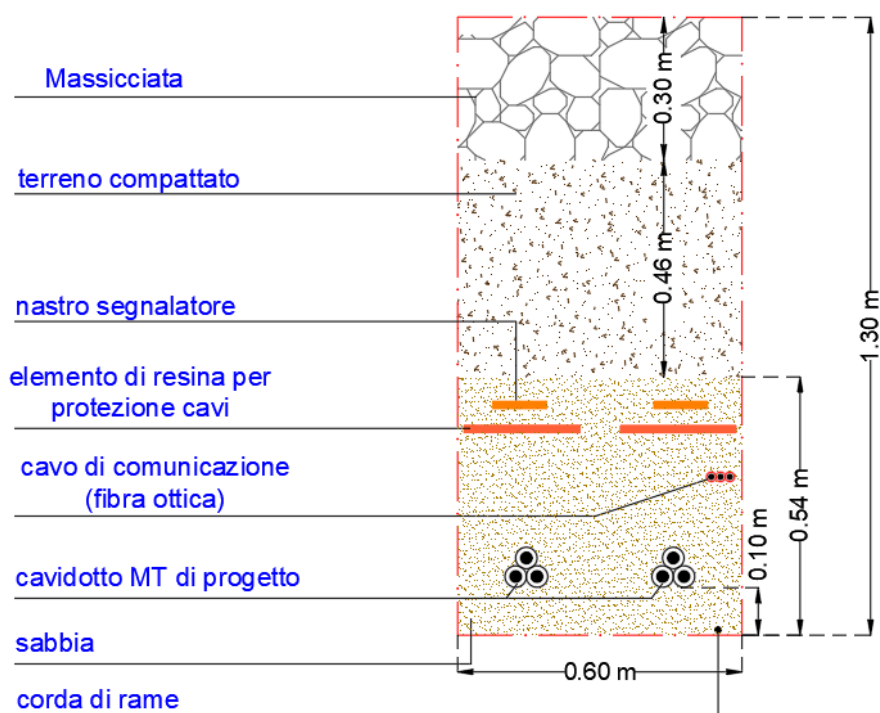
Sezione Cavidotto Doppia Terna su Strada Bianca
